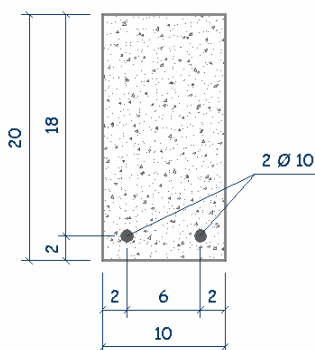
Seção transversal de concreto armado, cotas: cm.
